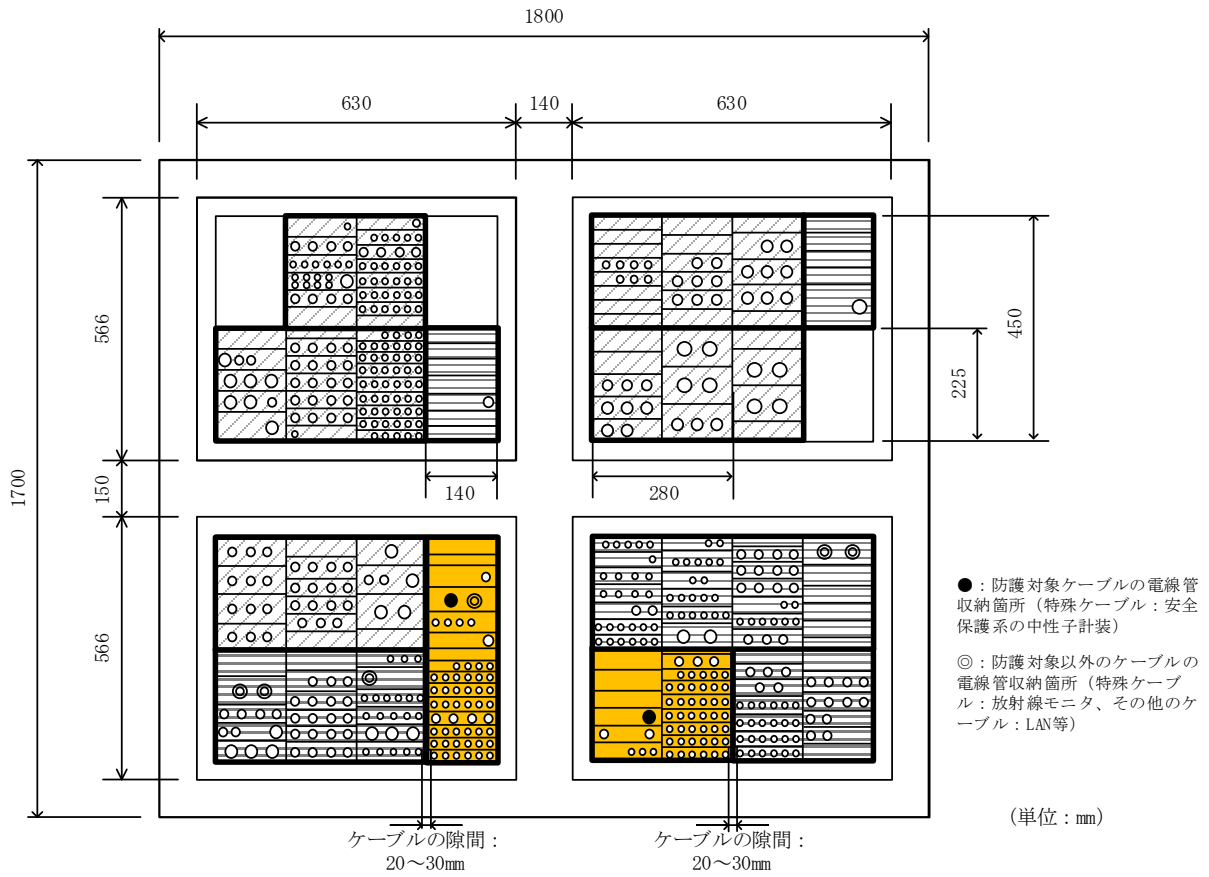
貫通部のケーブル詳細配置図 (原子炉建家側視点)
